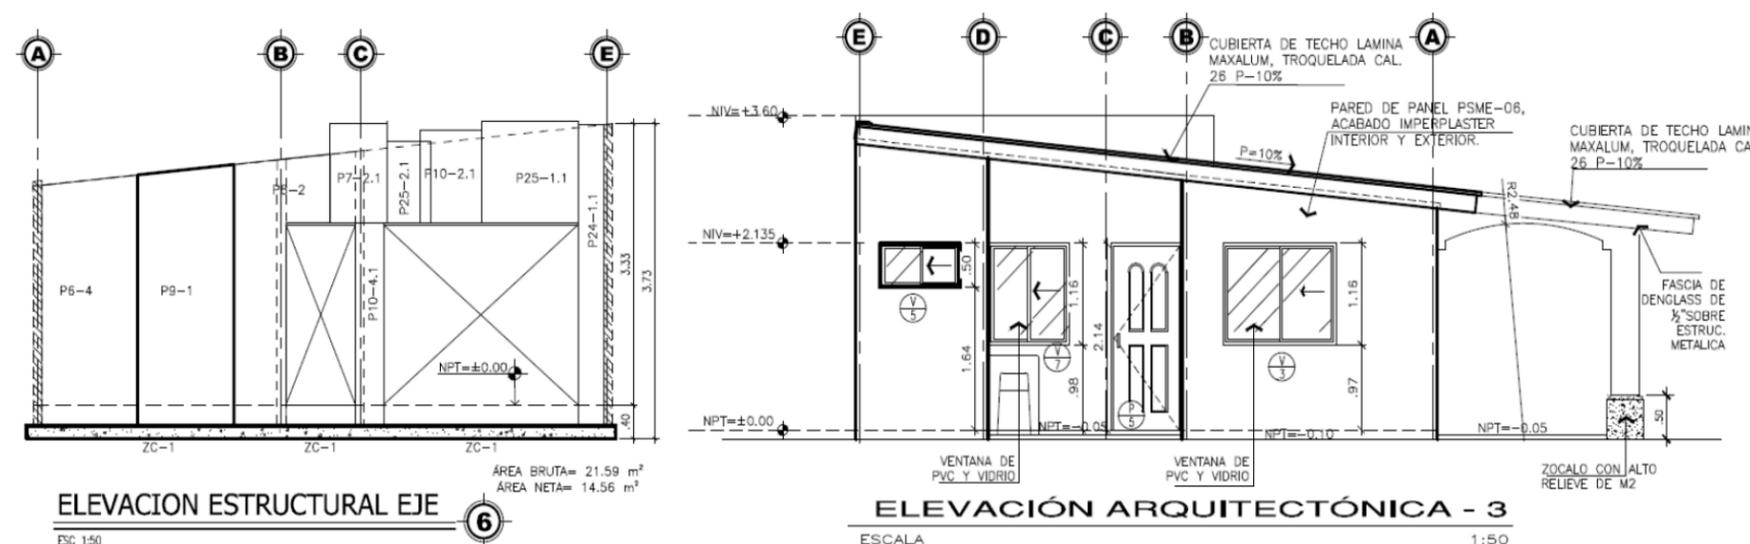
Elevación estructura y Arquitectónica, residencial Monte cielo. Fuente: Innicsa.com.
